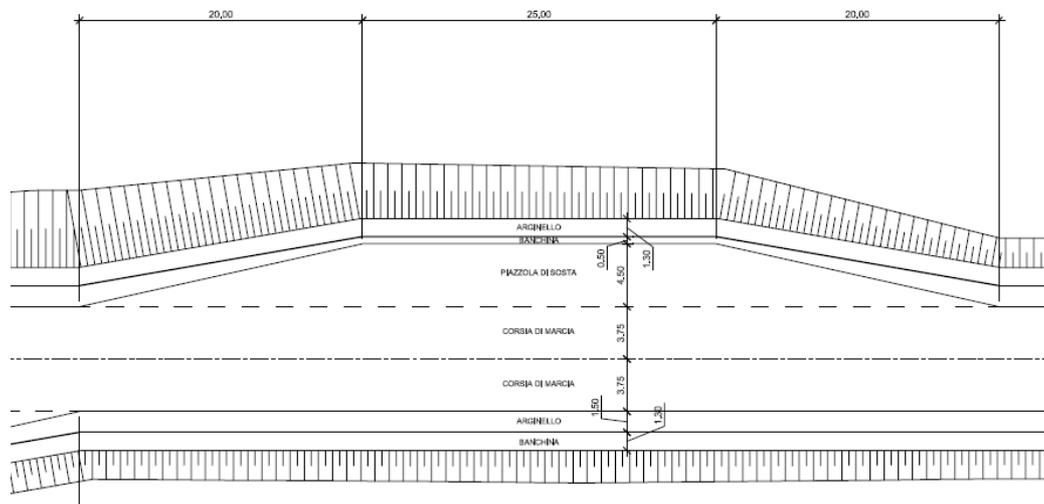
SCHEMA PLANIMETRICO DELLA PIAZZOLA DI SOSTA
